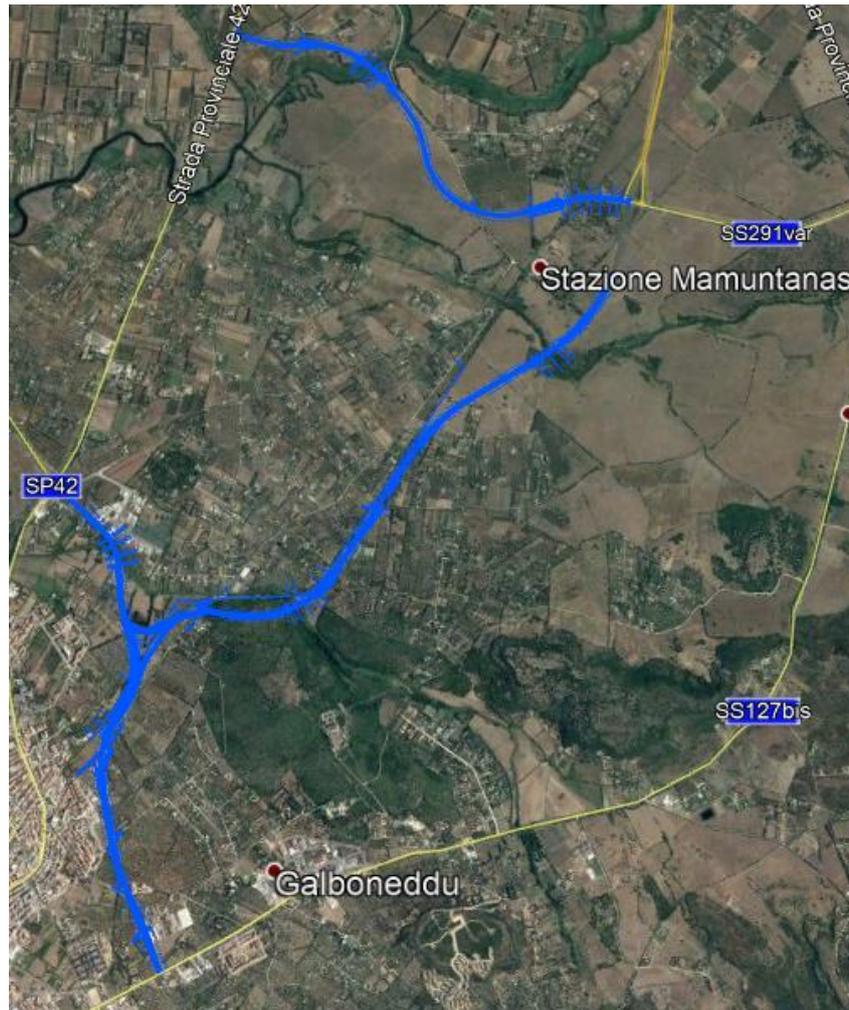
Localizzazione del tracciato di progetto su ortofoto
